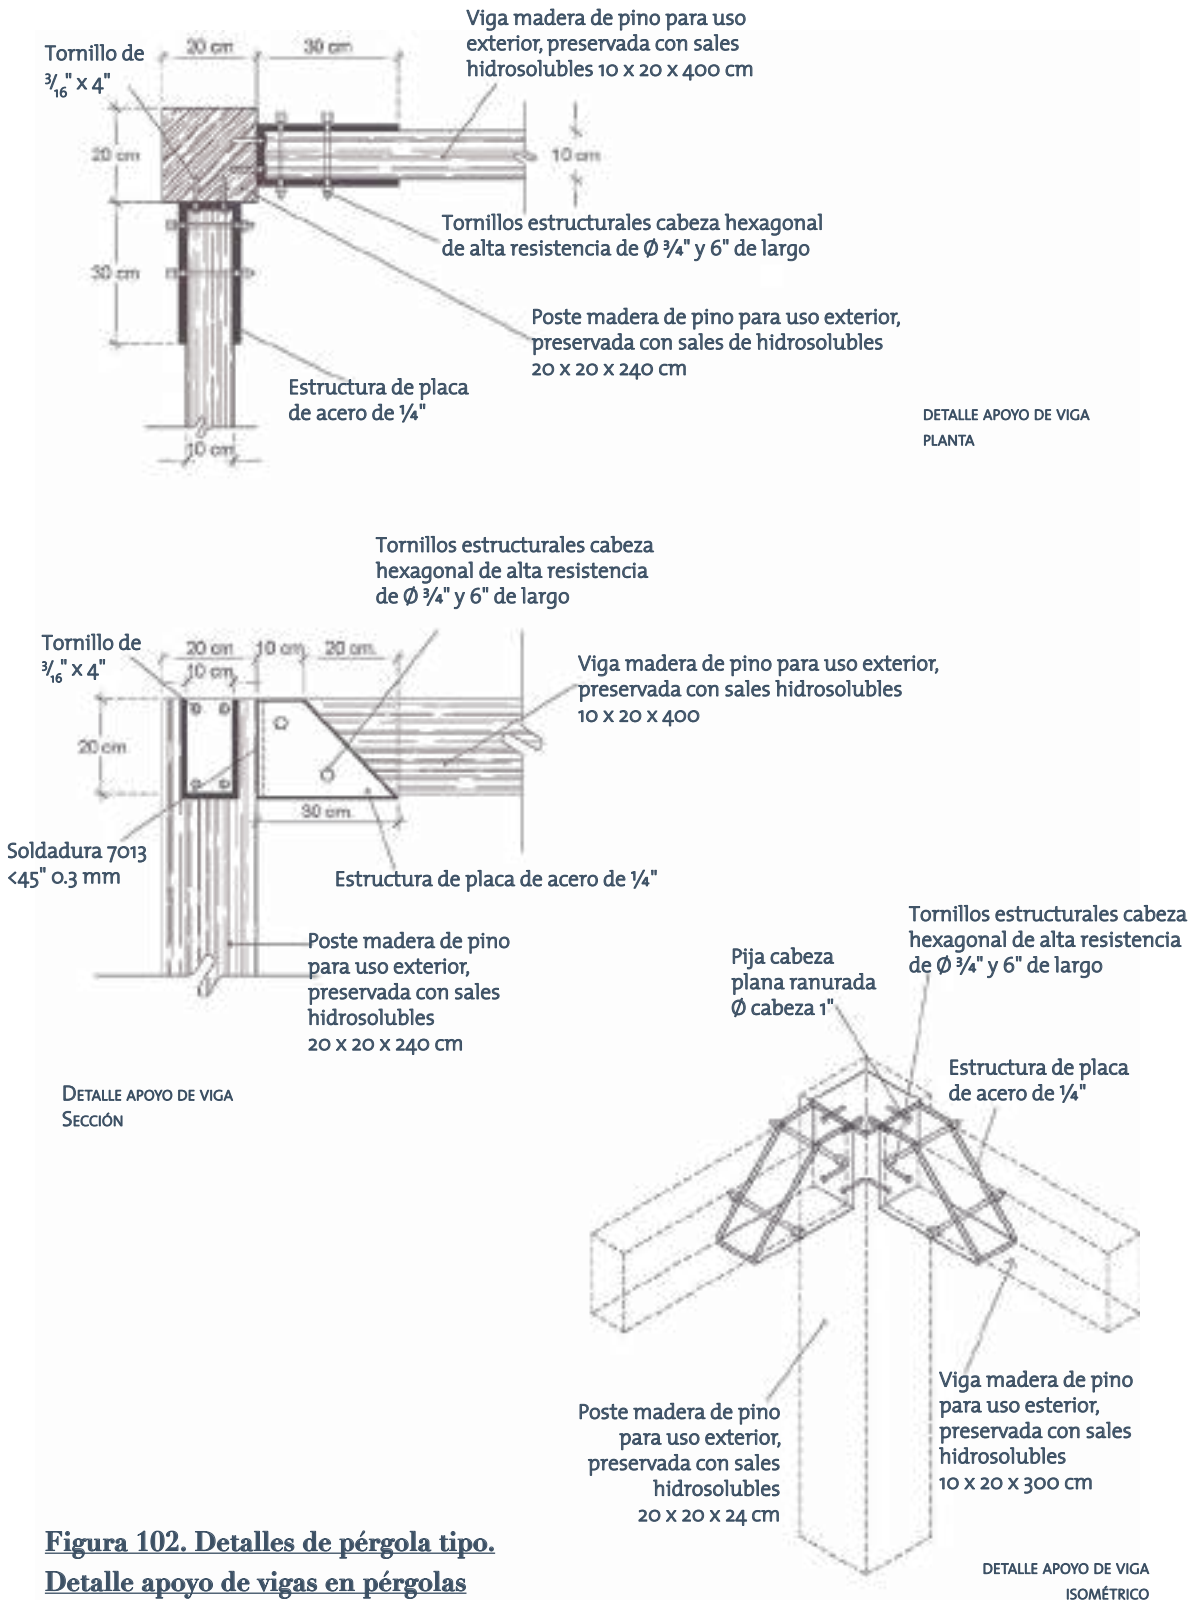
Detalles de pérgola tipo. Detalle apoyo de vigas en pérgolas
